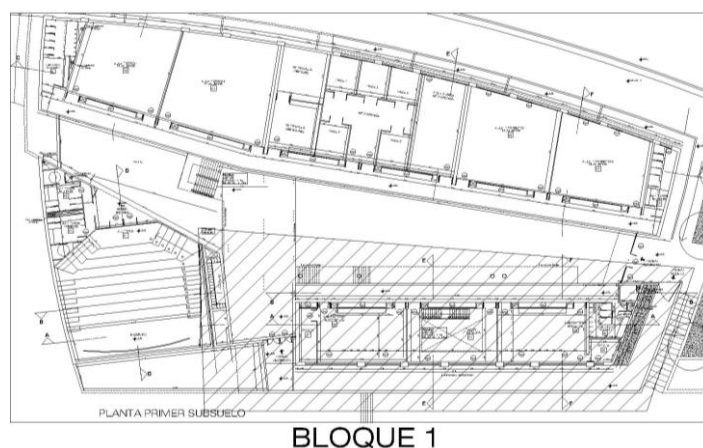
Planimetría general del proyecto. Identificación Bloque 1
